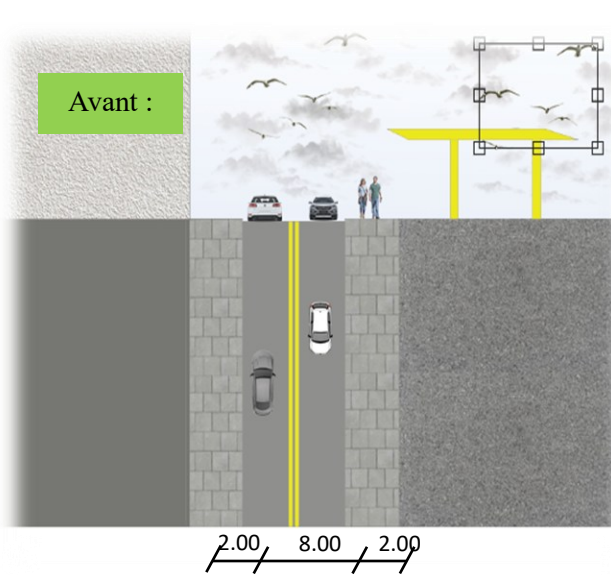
plan et coupe de boulevard Chabane Ahcene avant l'intervention.
